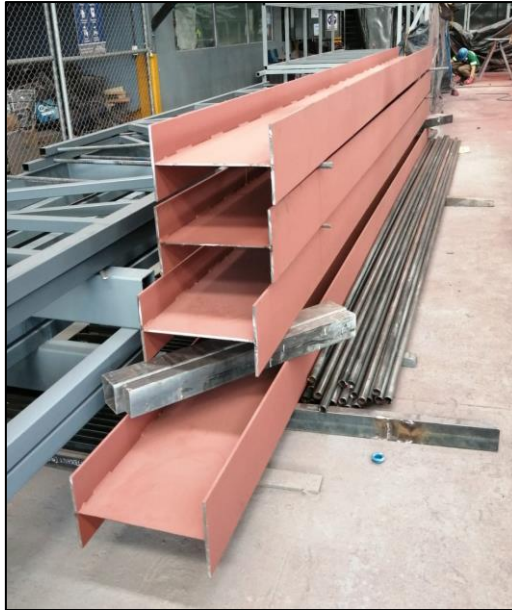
Vigas "hechizas" o armadas fabricadas a partir de lámina de acero
